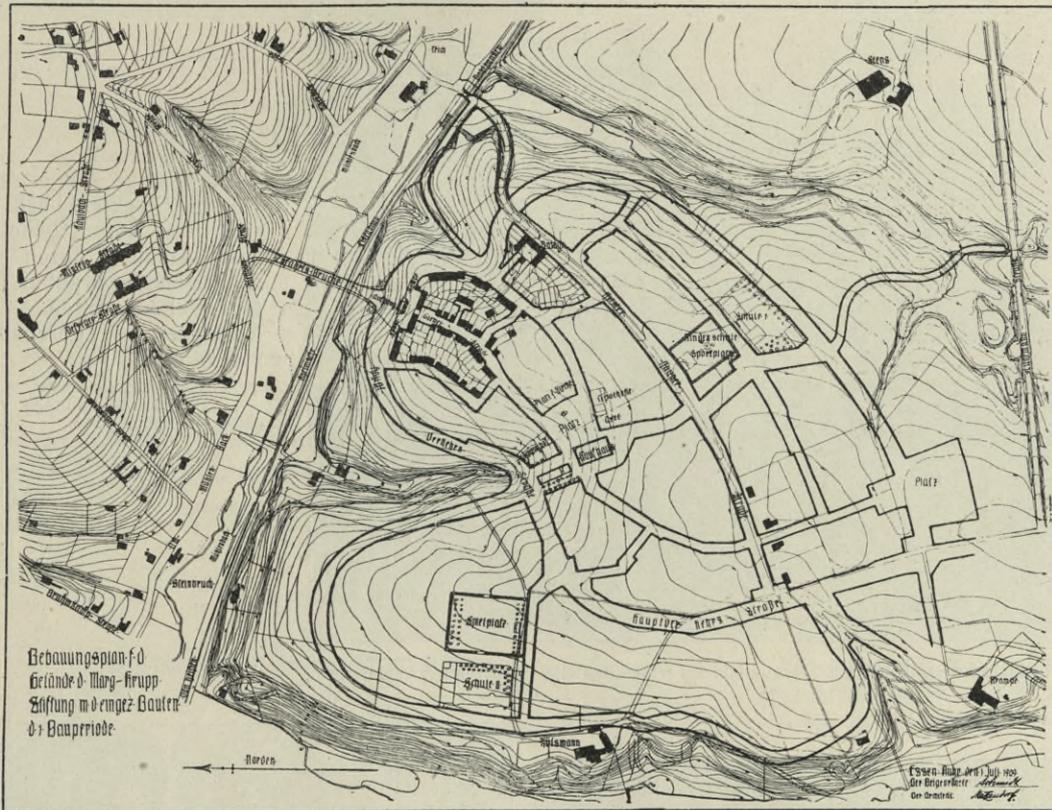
Bebauungsplan der Gartenstadt Margarethenhöhe zu Essen a. d. Ruhr
